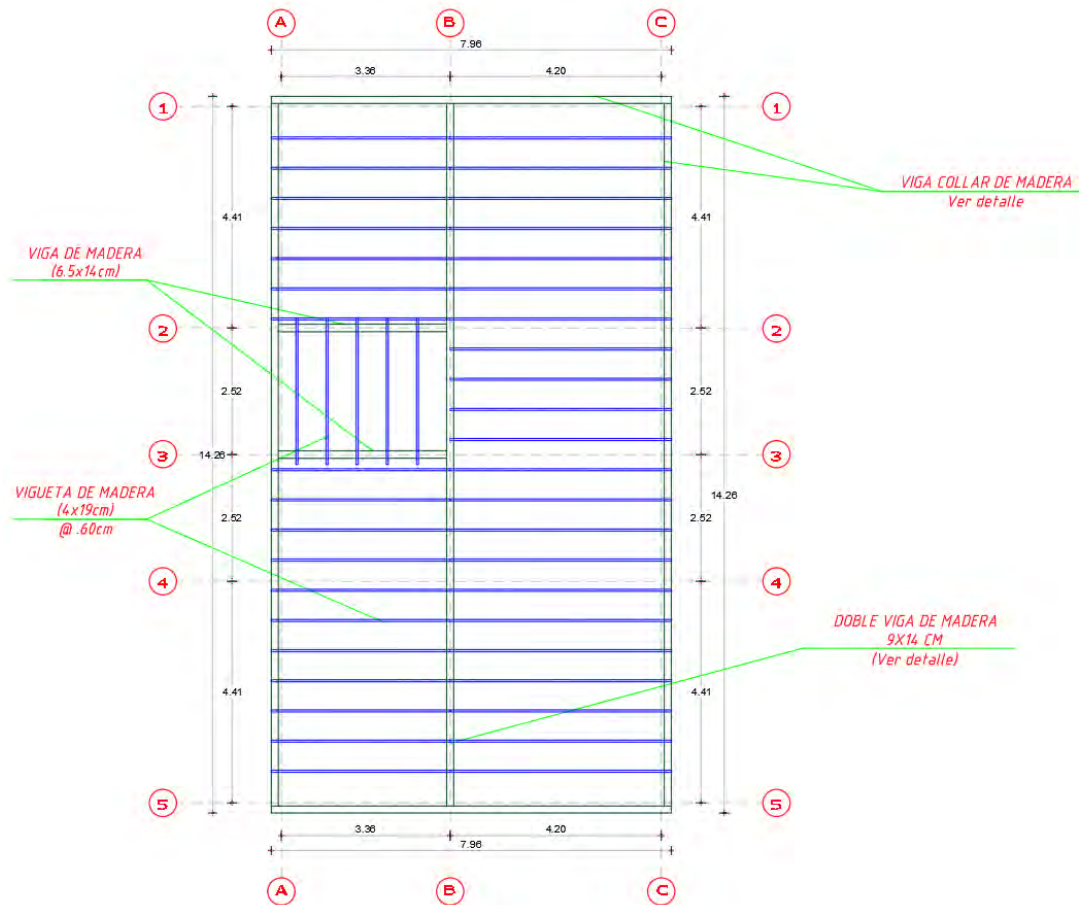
Plano de viguetas de techo en la edificación de Pampacolca
